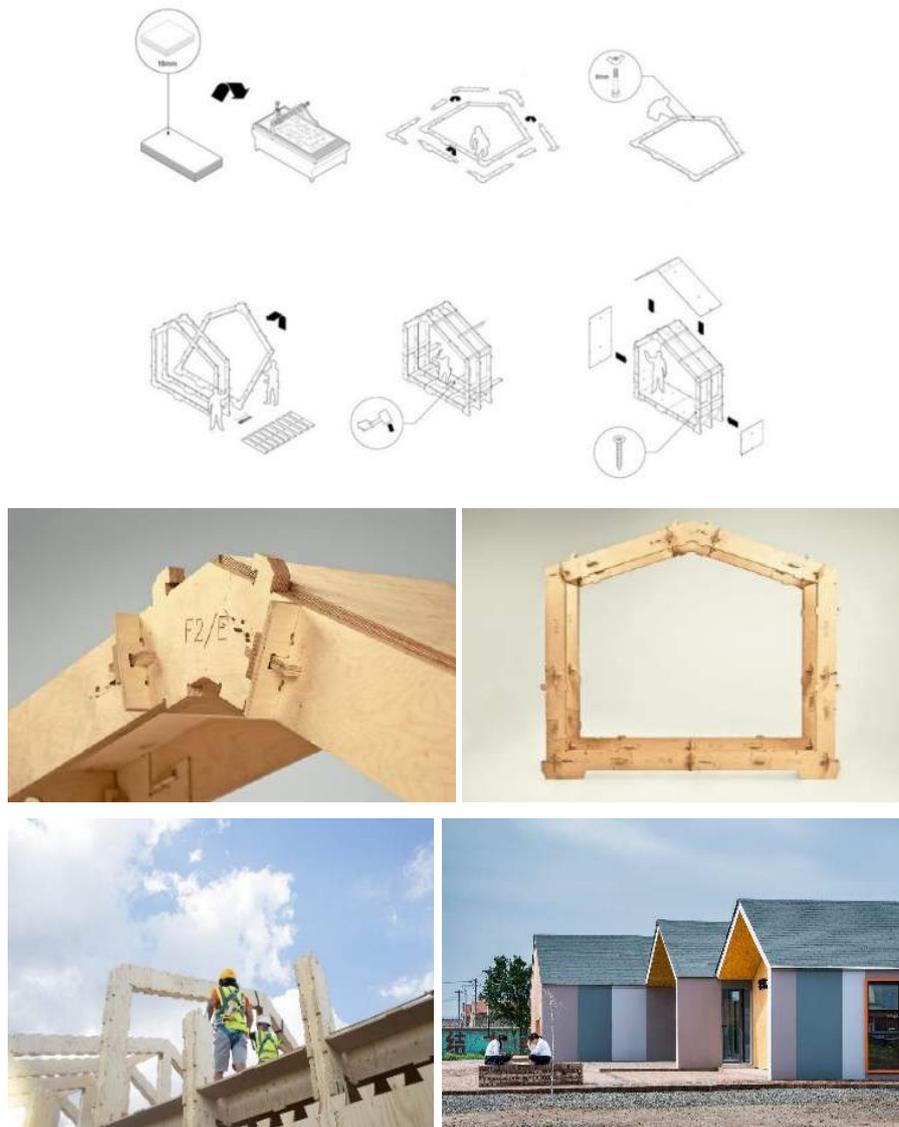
Fase de construção WikiHouse 3D (Wikihouse, 2019)
